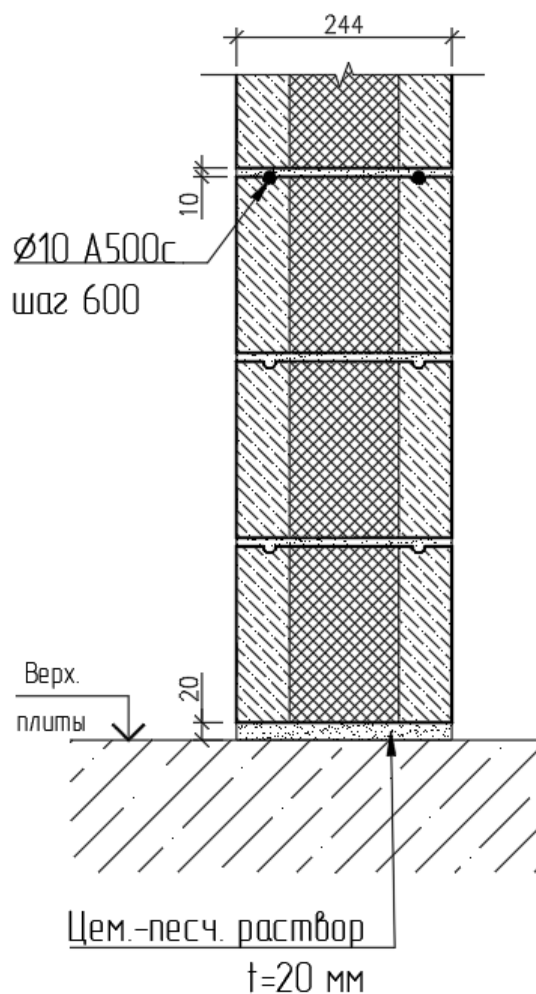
Сечение Д-Д. Горизонтальное армирование кладки верхних рядов в разрезе.
